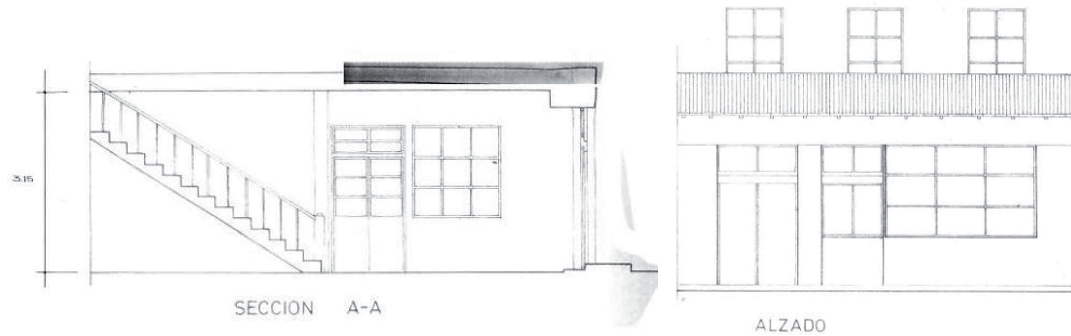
14. 1973 SECCIÓN Y ALZADO DE PLANTA BAJA ANTES DE LA REFORMA
